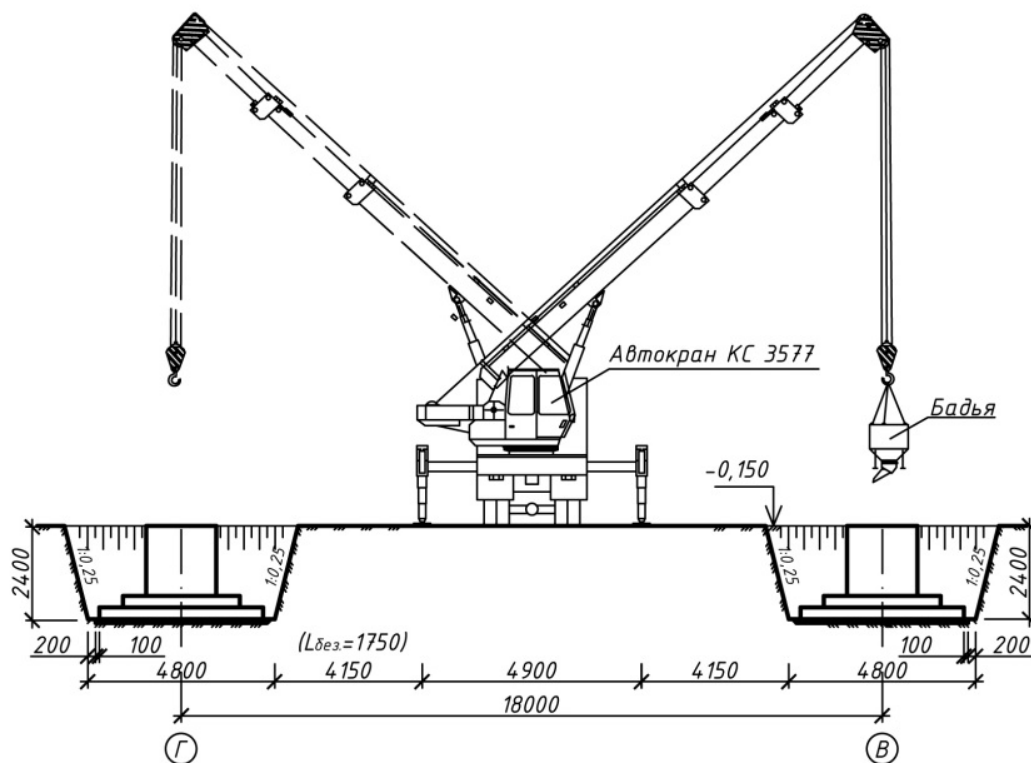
Схема установки машин и механизмов на откосе выемки
